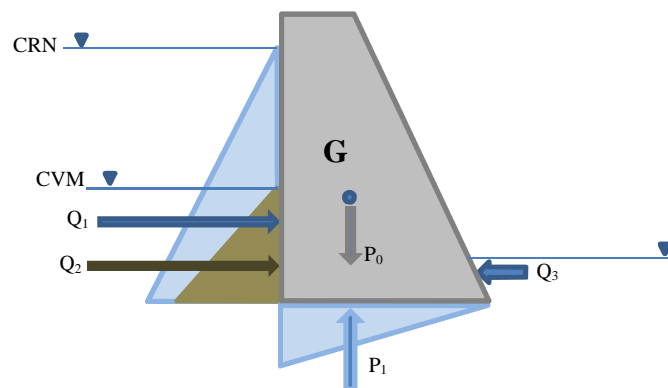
Forces agissant sur la stabilité d'un barrage poids
